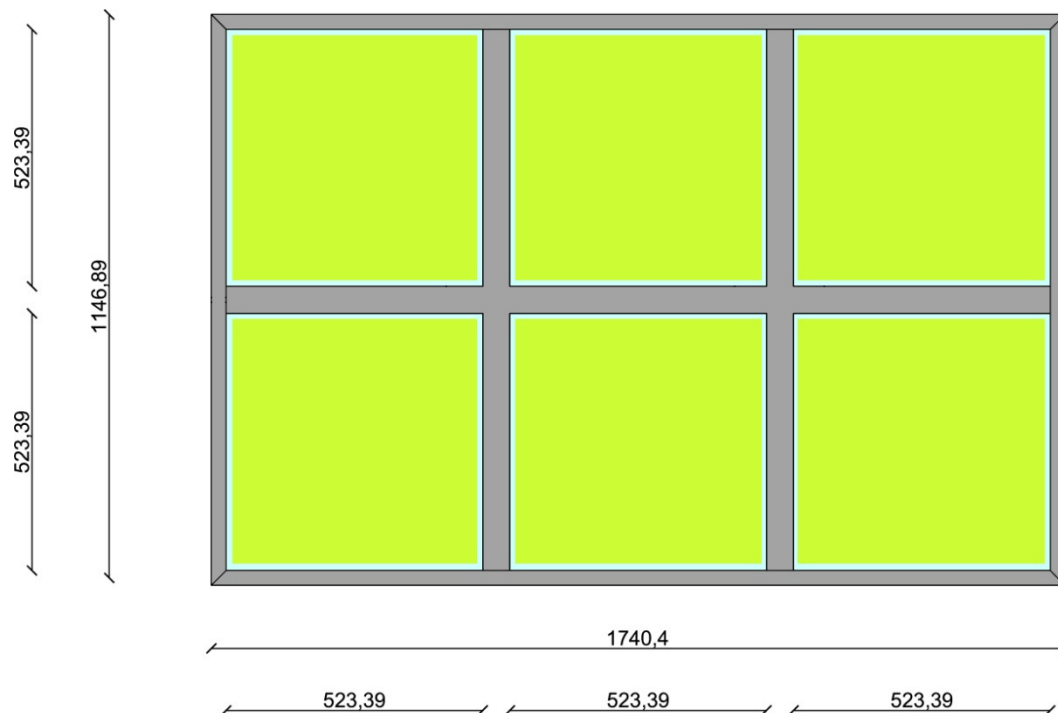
Prospetto del nuovo modulo LSC con collegamenti elettrici dei tra i pannelli LSC
